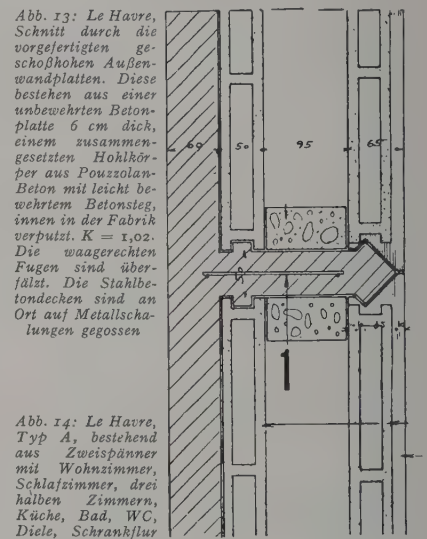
Le Havre, Schnitt durch die vorgefertigten, geschloßten Außenwandplatten. Diese bestehen aus einer unbewehrten Betonplatte 6 cm dick, einem zusammen-gesetzten Hohlkörper aus Porenbeton mit leicht bewehrtem Betonsteig, innen in der Fabrik verputzt. K = 1,02. Die waagerechten Fugen sind überfälscht. Die Stahlbetondecken sind an Ort auf Metallschalungen gegossen
